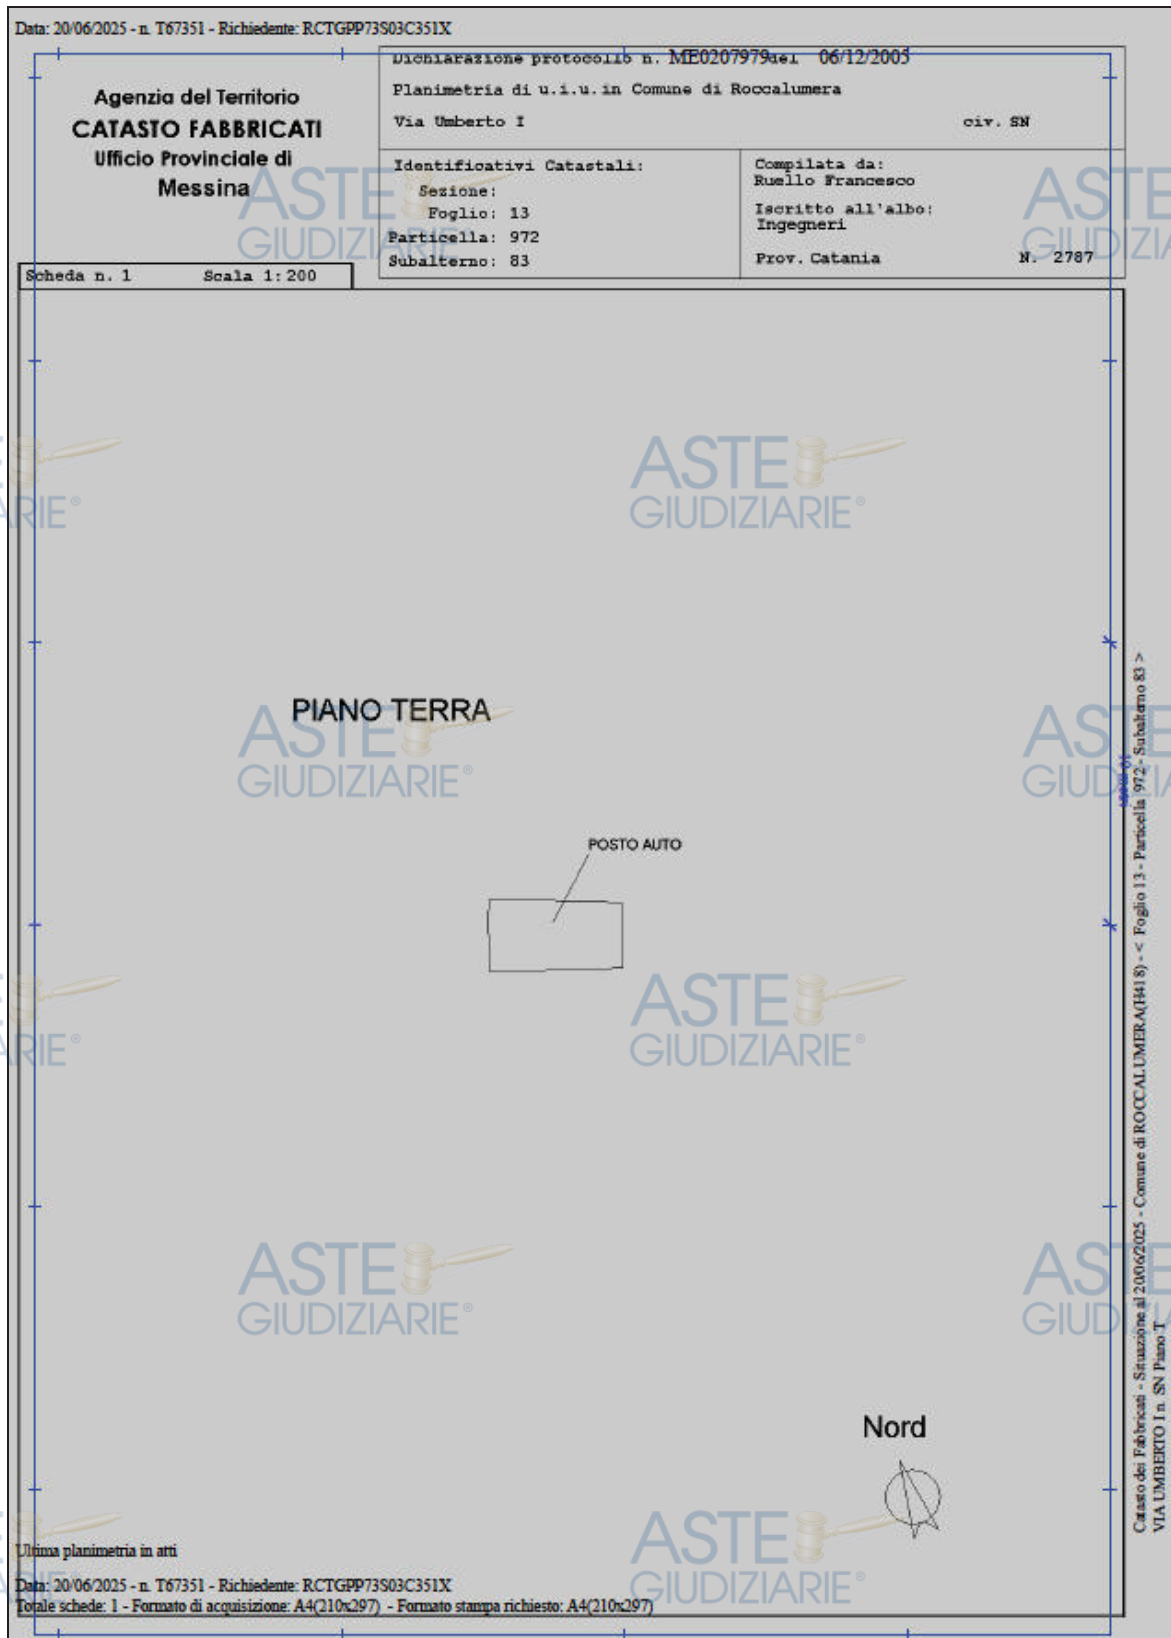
Visualizzazione della planimetria catastale del posto auto esterno individuato con il sub. 83
